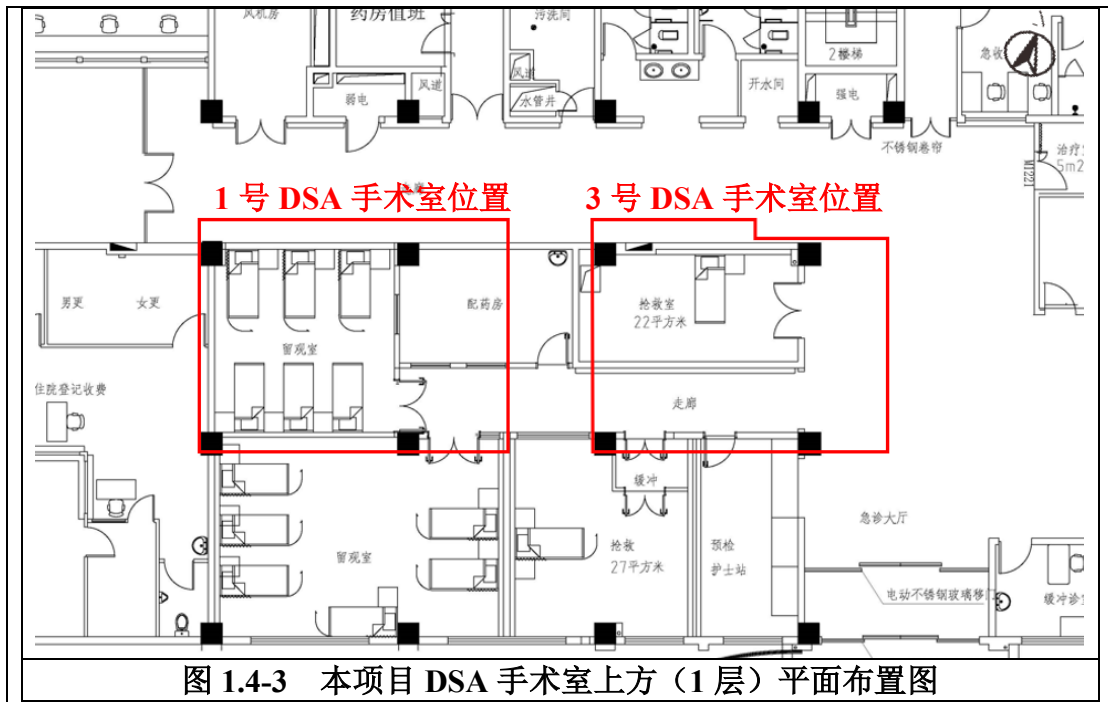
本项目 DSA 手术室上方（1层）平面布置图
